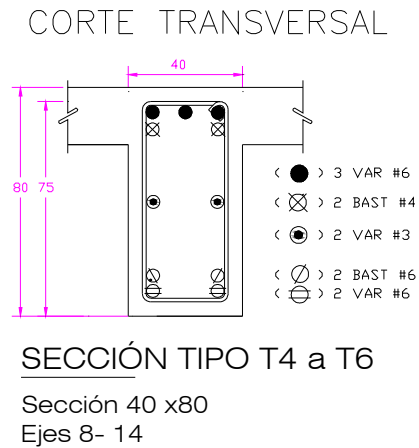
13 Detalle de armado de contratrabe T4 a T6. Corte transversal
